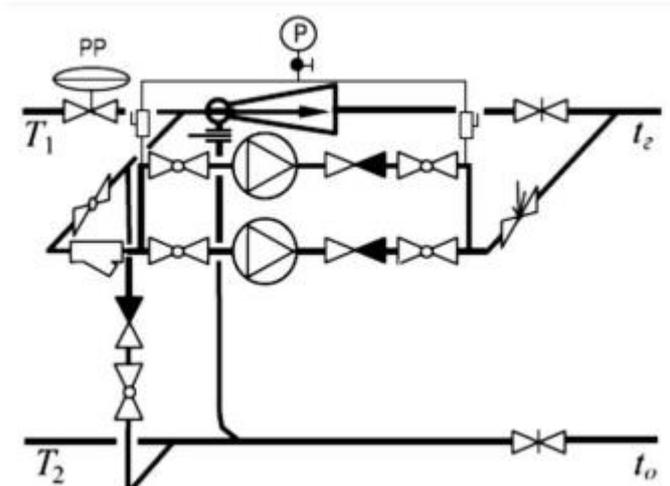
Параллельное гидроэлеватору размещение насосного узла
